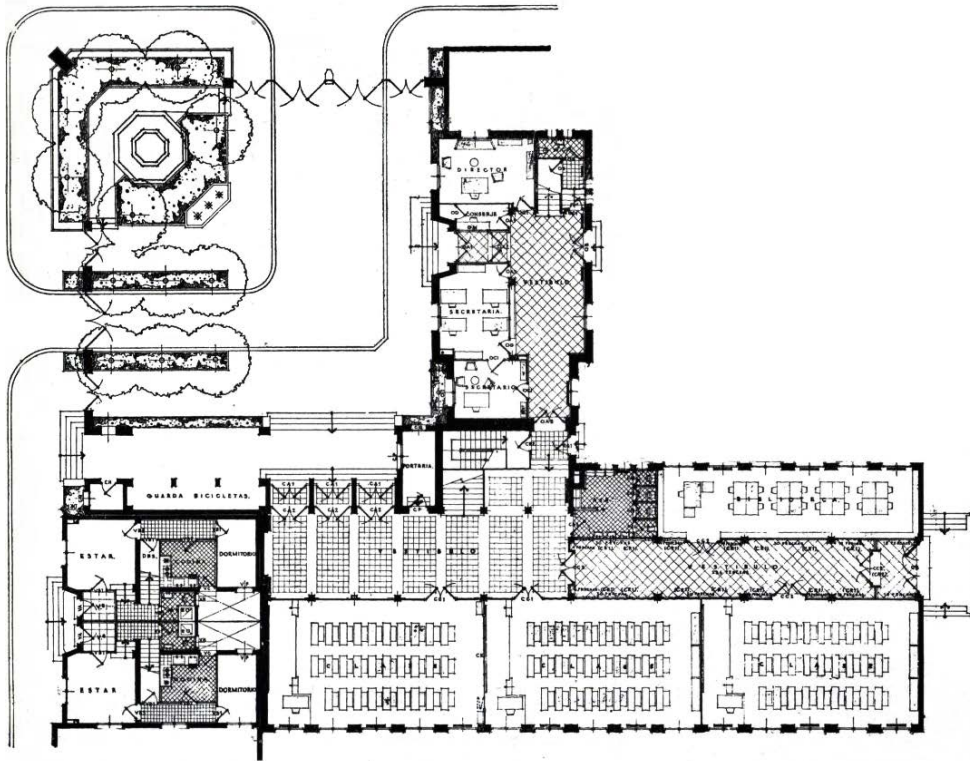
Plano. Planta baja del pabellón de clases, oficinas y viviendas del Instituto Laboral de Tarazona, por el arquitecto Alejandro Allanegui, abril de 1951 (*Revista Nacional de Arquitectura*, enero de 1954, colección privada).
